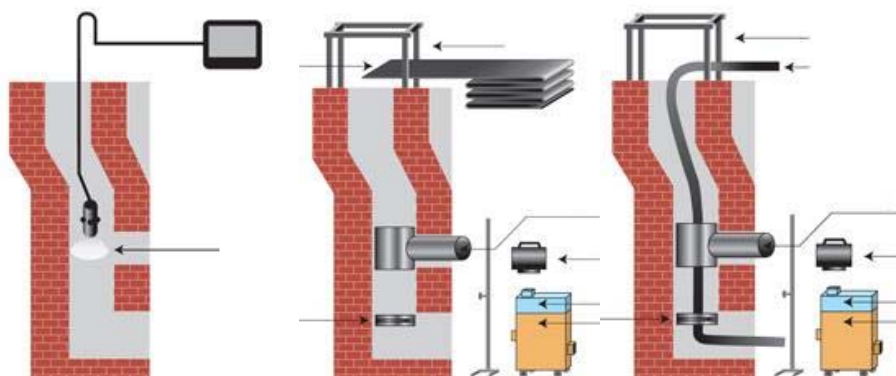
Обследование. Установка и протягивание заготовки в дымоход
